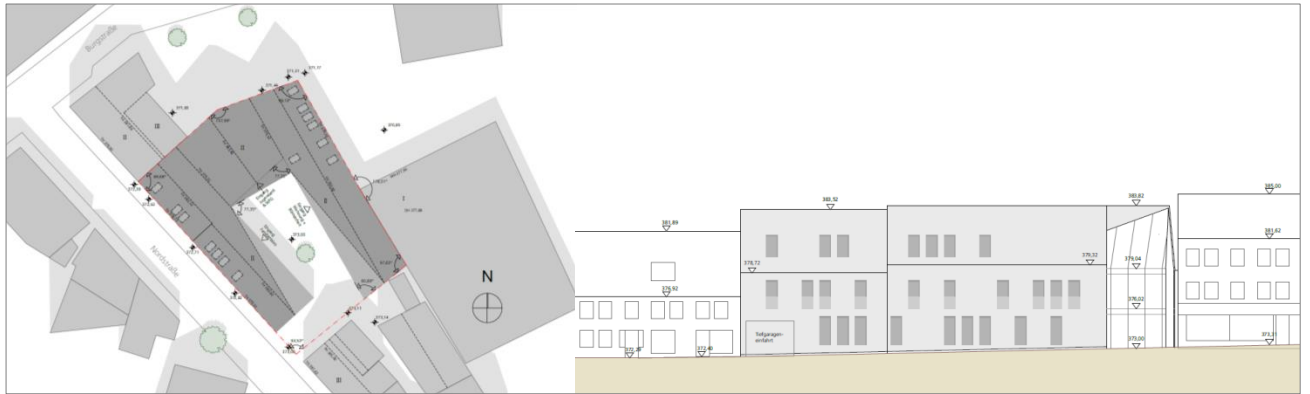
Vorentwurf Nordstraße 4-8, Lageplan/ Dachaufsicht und Ansicht Nordstraße
